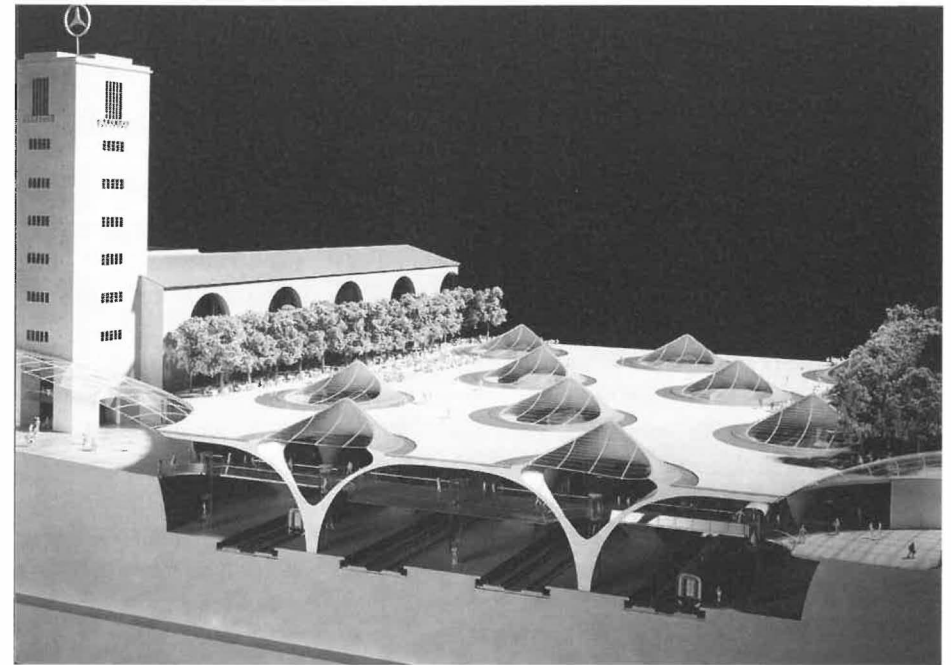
Schnitt durch die projektierte neue Bahnsteighalle. Rechts neben dem Bahnhofsturm erkennt man hinter dem Gebüsch die bestehende Querbahnsteighalle, über die derzeit der Zugang zu den Gleisen erfolgt. Das gelöcherte Dach der unterirdischen Bahnsteighalle mit seinen »Lichtaugen« soll als städtebauliches Scharnier zwischen der bestehenden City und dem neuen Stadtteil »Stuttgart 21« dienen (Bild: DBProjekt GmbH Stuttgart 21).
